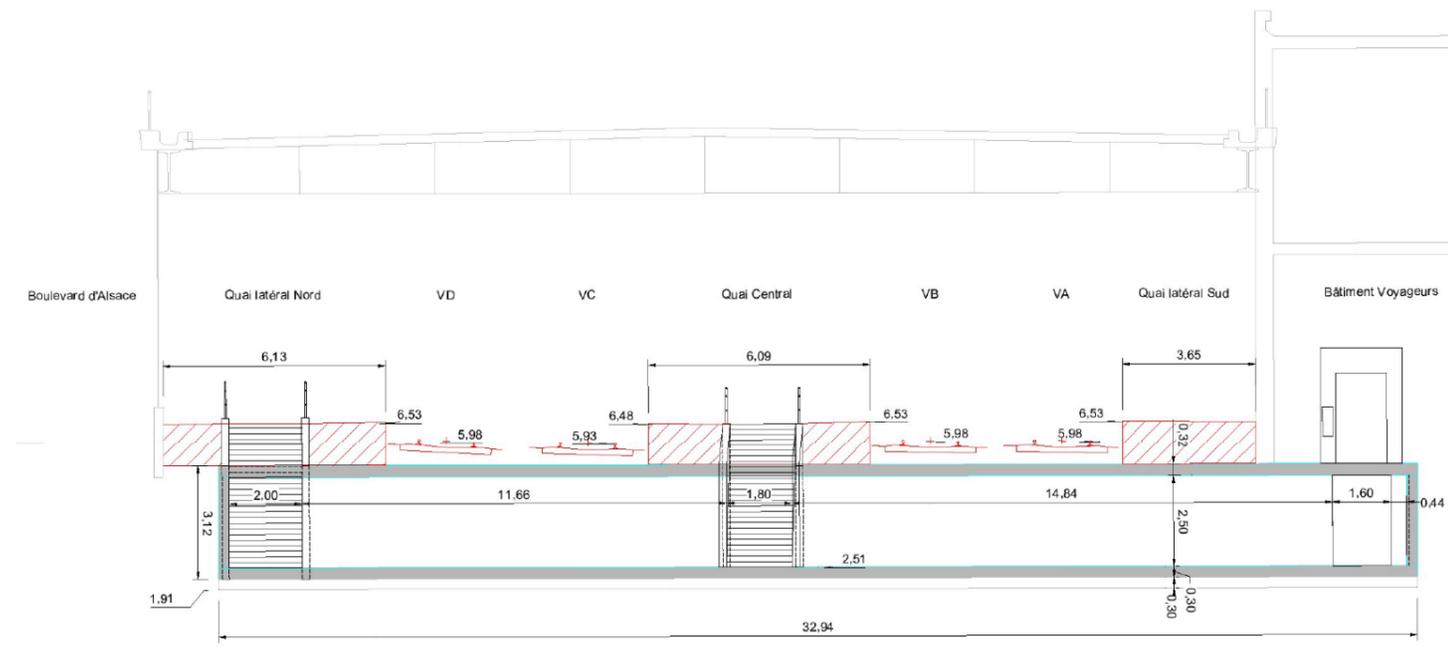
Coupe du passage souterrain voyageurs ouest (Systra, 2021)
